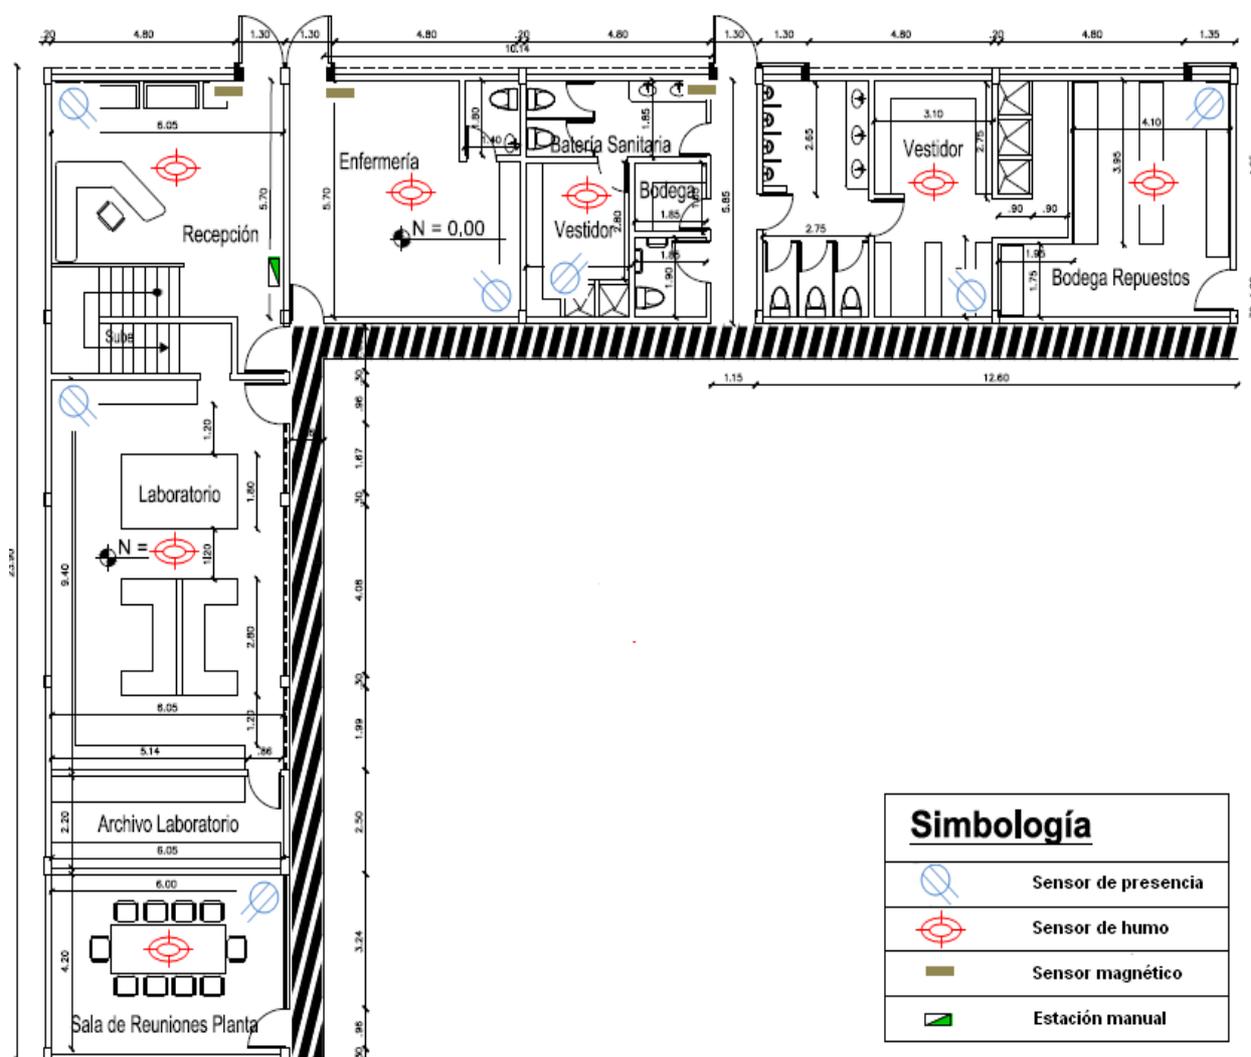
Plano esquemático de la oficina planta baja, tomado de [1.1].
